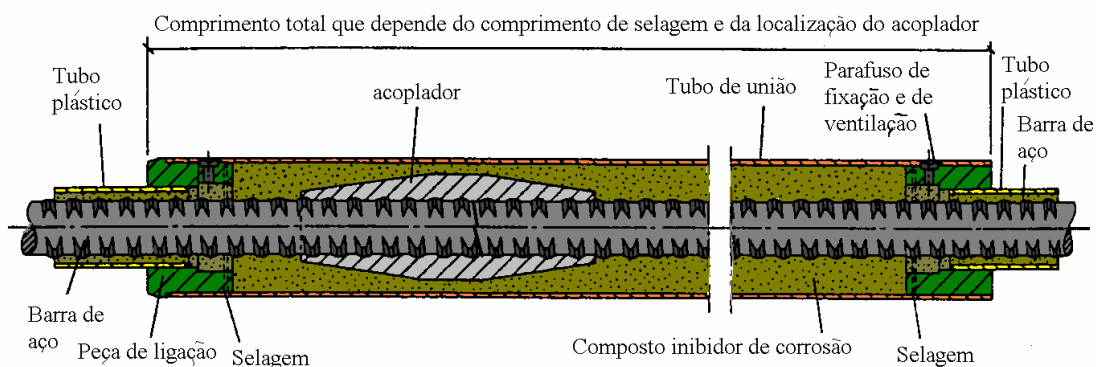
Corte longitudinal do comprimento livre de uma ancoragem de uma junta de ligação de barras [9]
